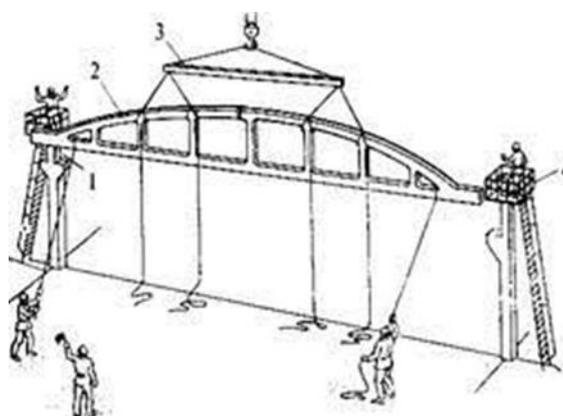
Монтаж железобетонной стропильной фермы.
